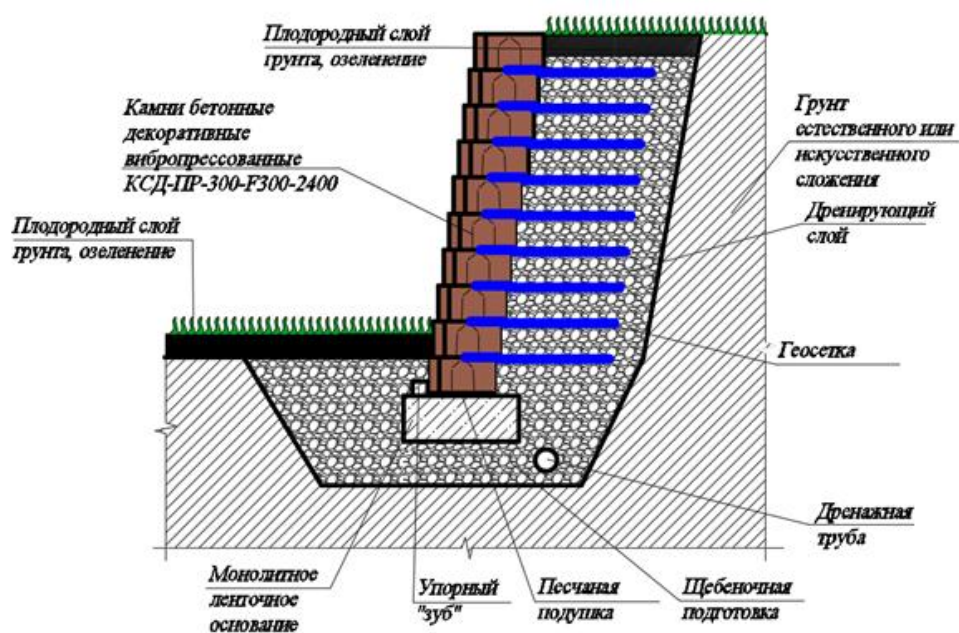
Принципиальная схема устройства подпорной стенки из камней с устройством слоев из армирующих геосеток
